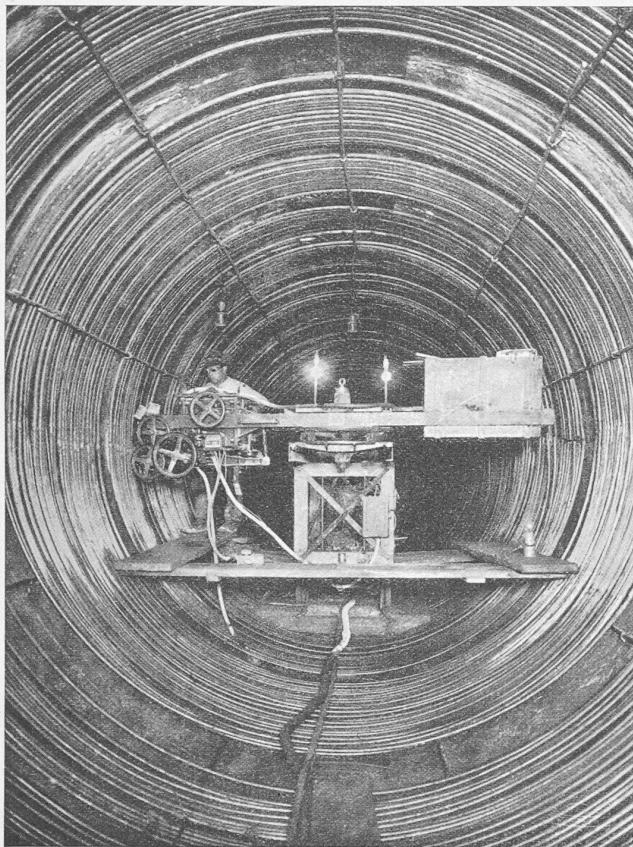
Schweissen der Ringarmierung im obern Druckstollen.
